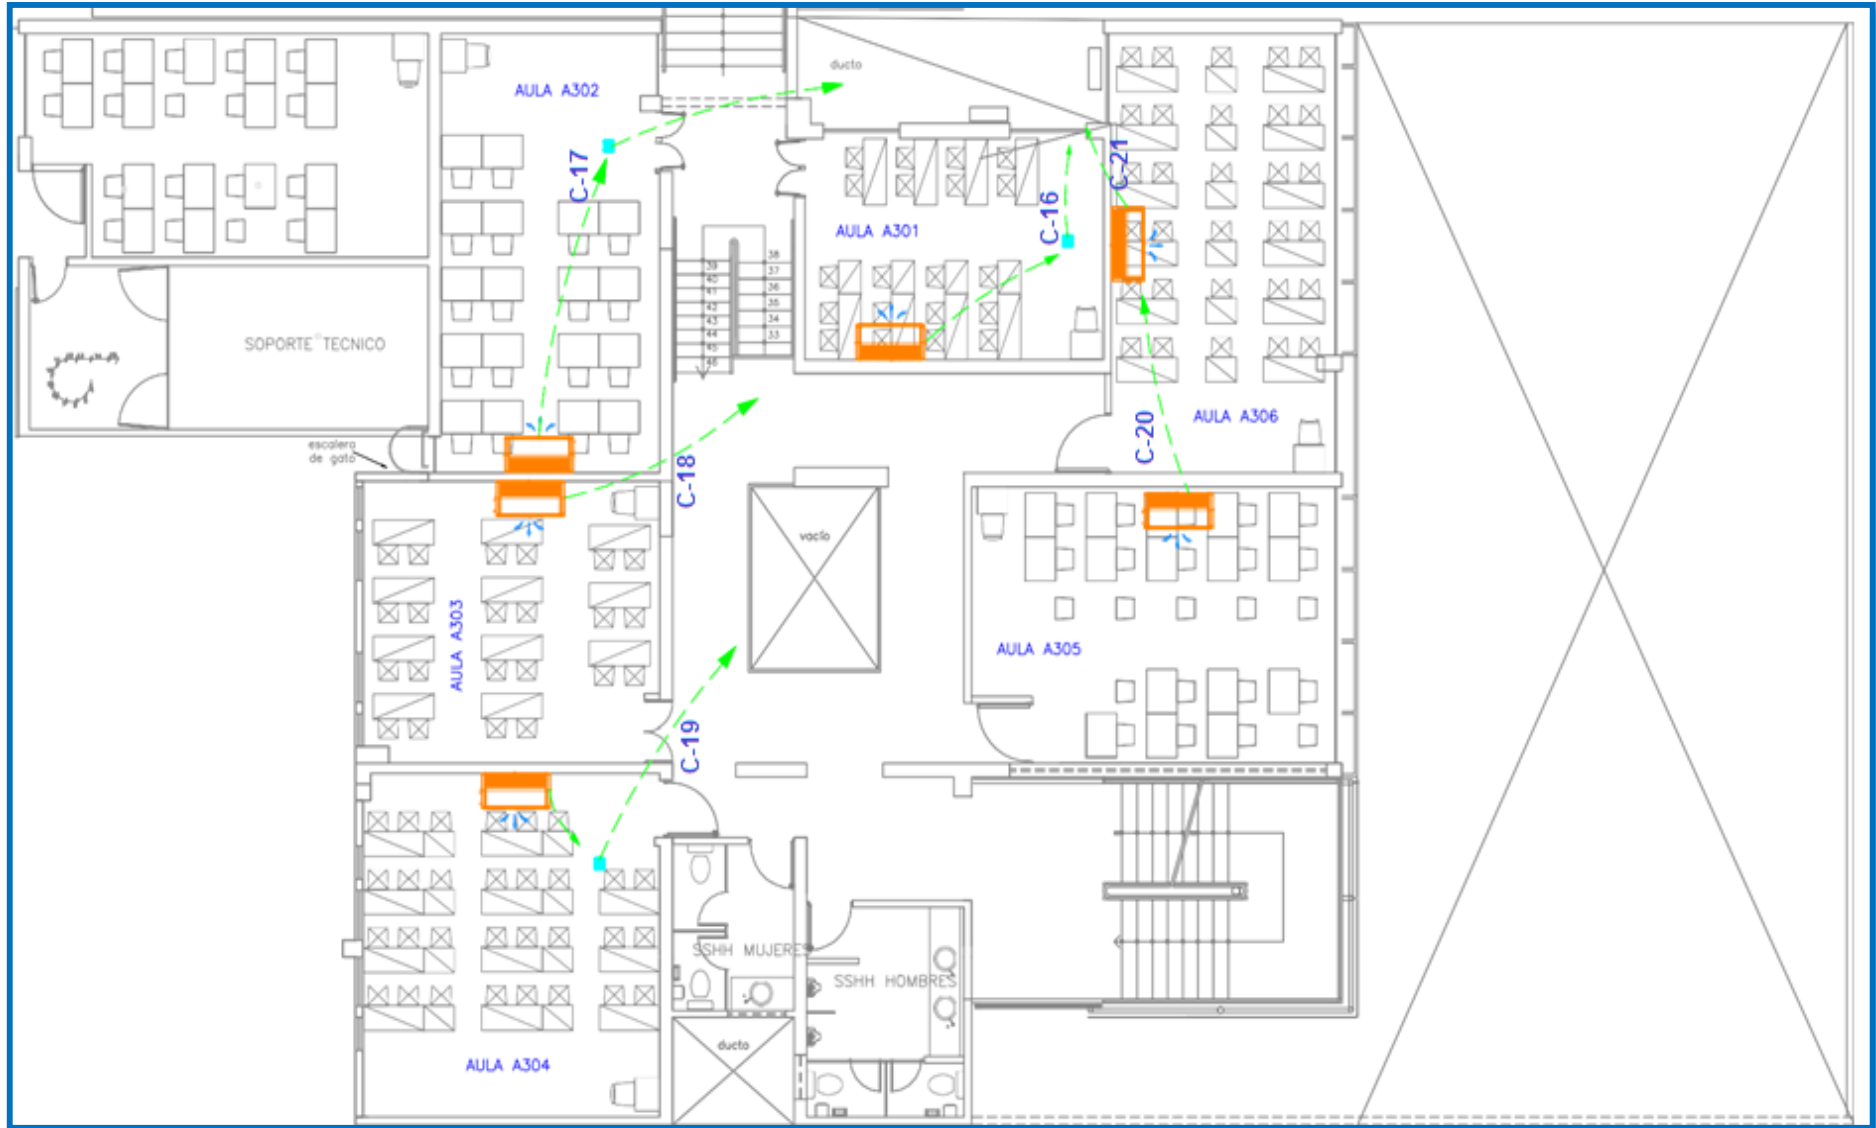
Plano de la tercera planta – Instituto Privado Toulouse Lautrec.
